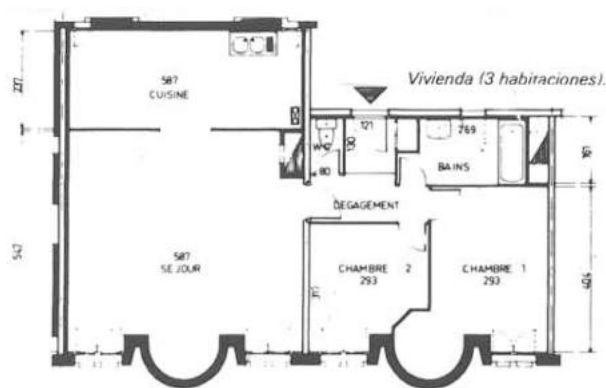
Ejemplo de tipología de viviendas. Fuente: revista Informes de la Construcción.
